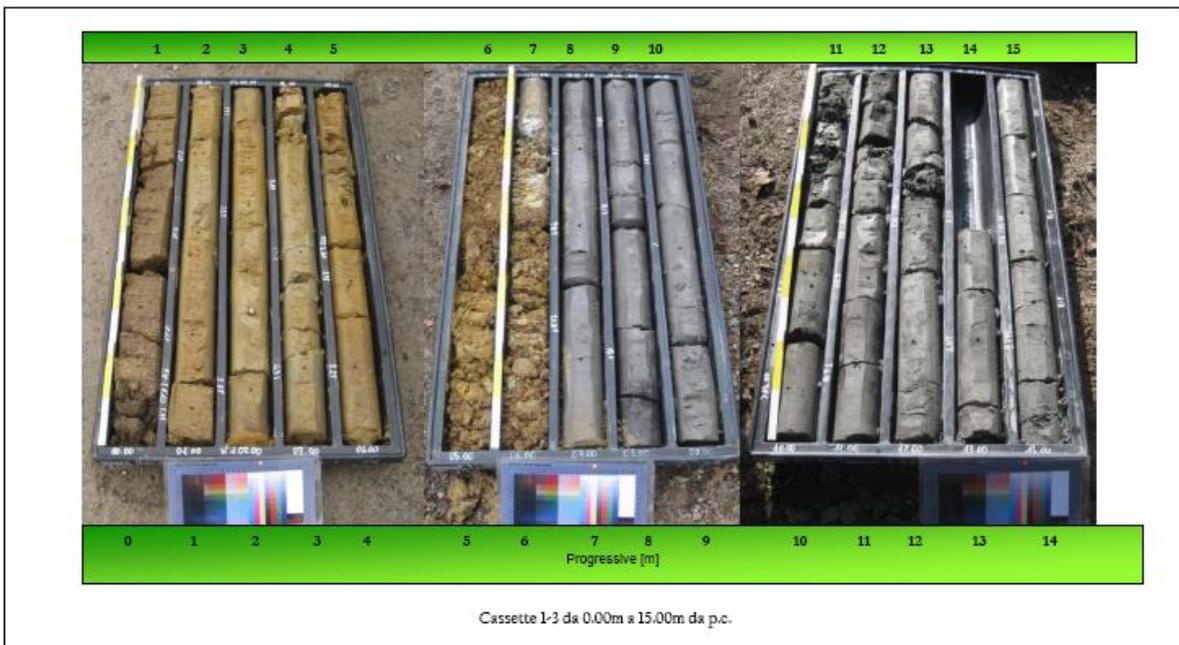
Carote estratte dal sondaggio S2 (da 0 a 15 m dal p.c.)
